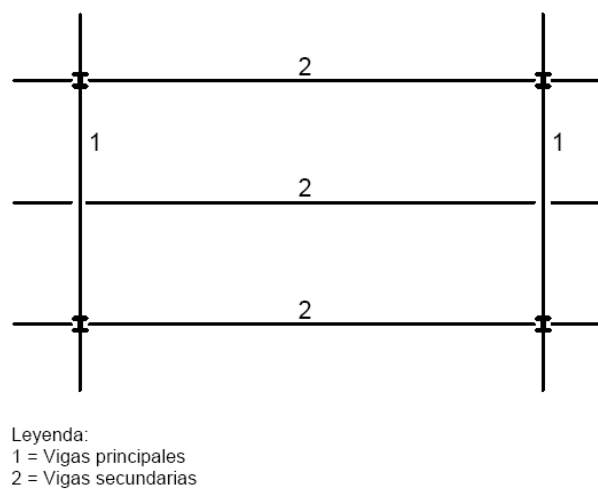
Disposición de vigas en una distribución rectangular; vigas secundarias más largas.
